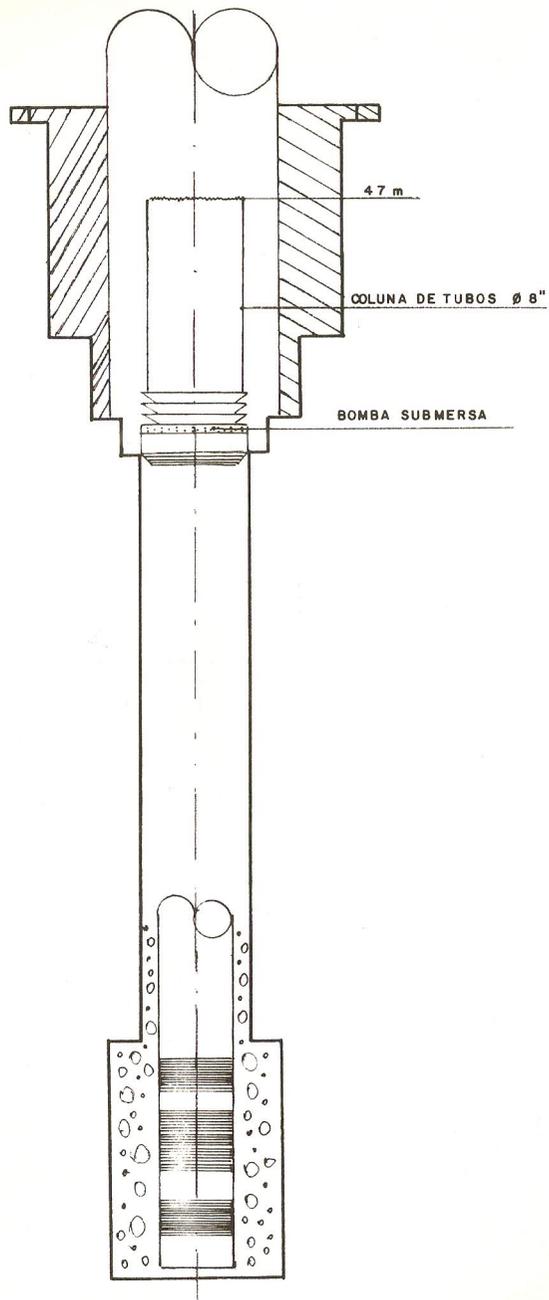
QUEDA DE TUBOS DE RECALQUE E BOMBA SUBMERSA
